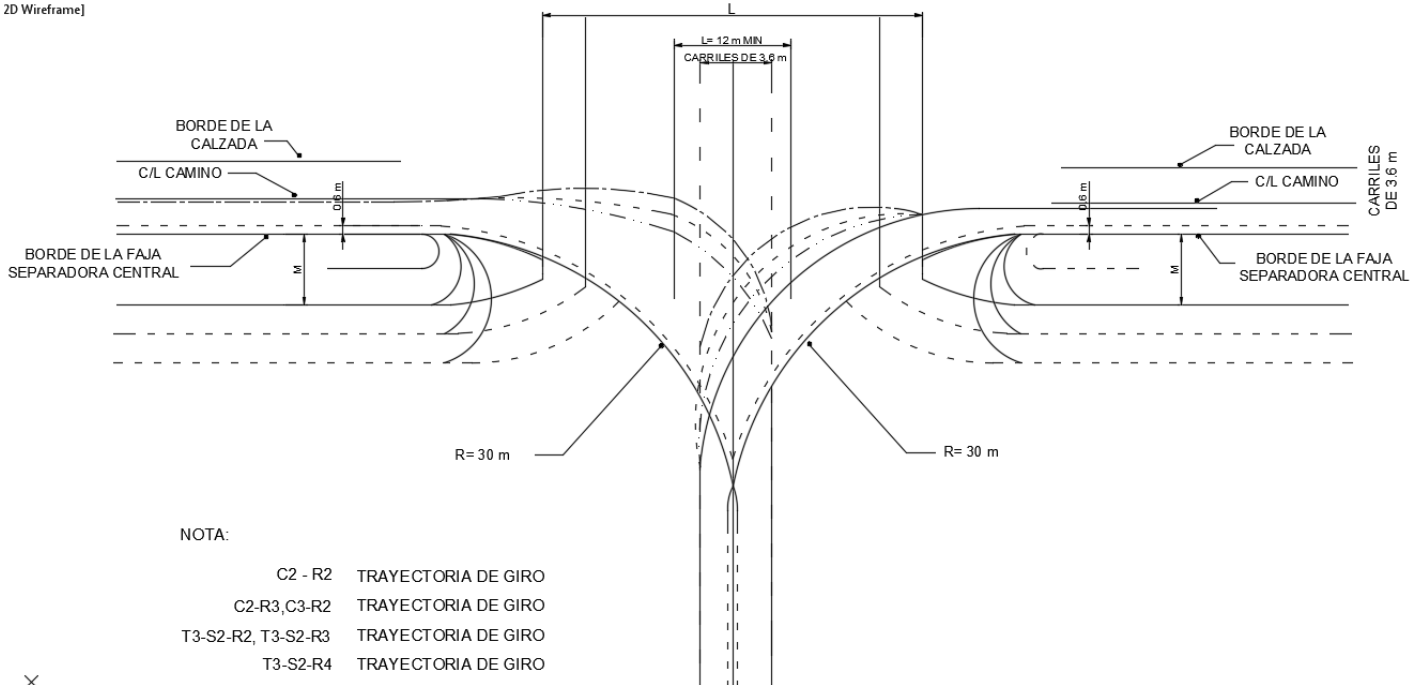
Diseños de apertura mínima en la faja separadora central (vehículo de proyecto C2-R2, radio de control de 30 m)
